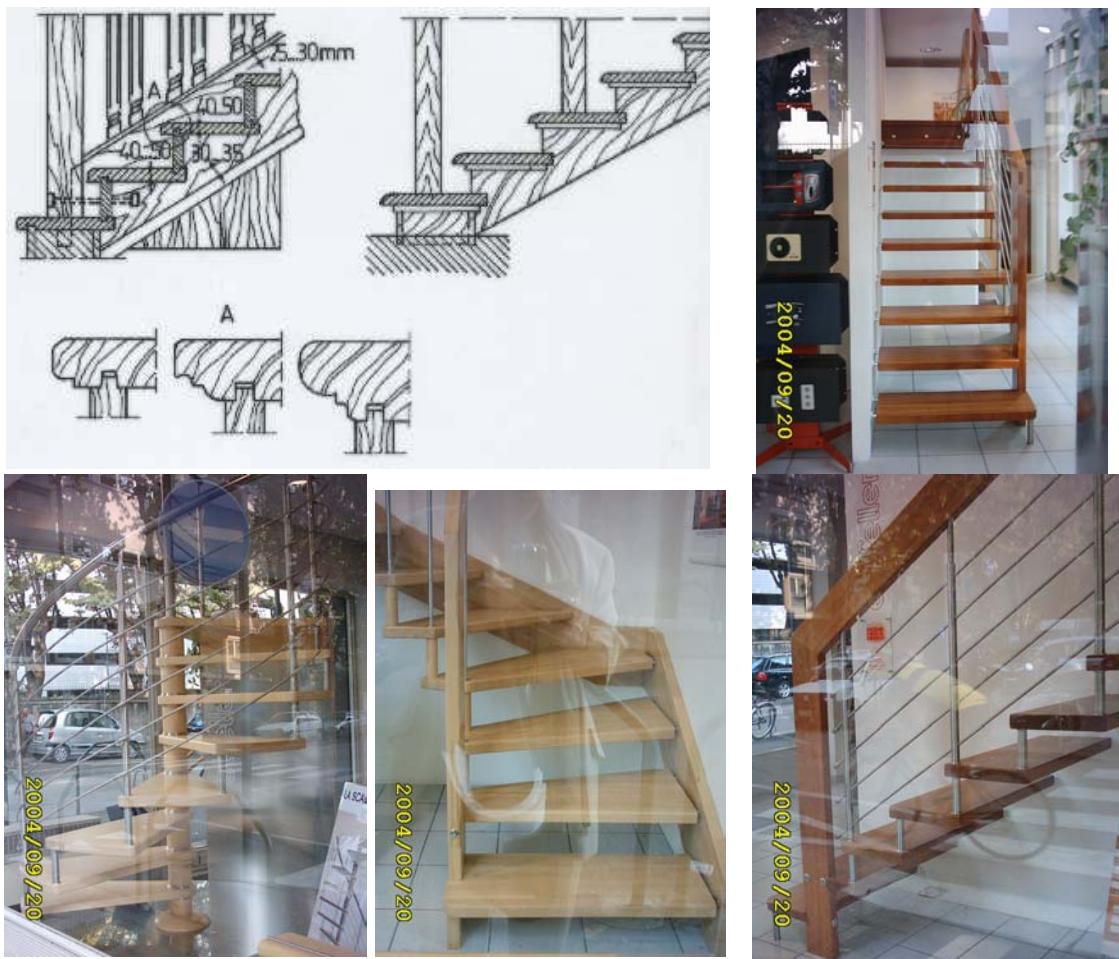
Scari din lemn – detalii constructive
